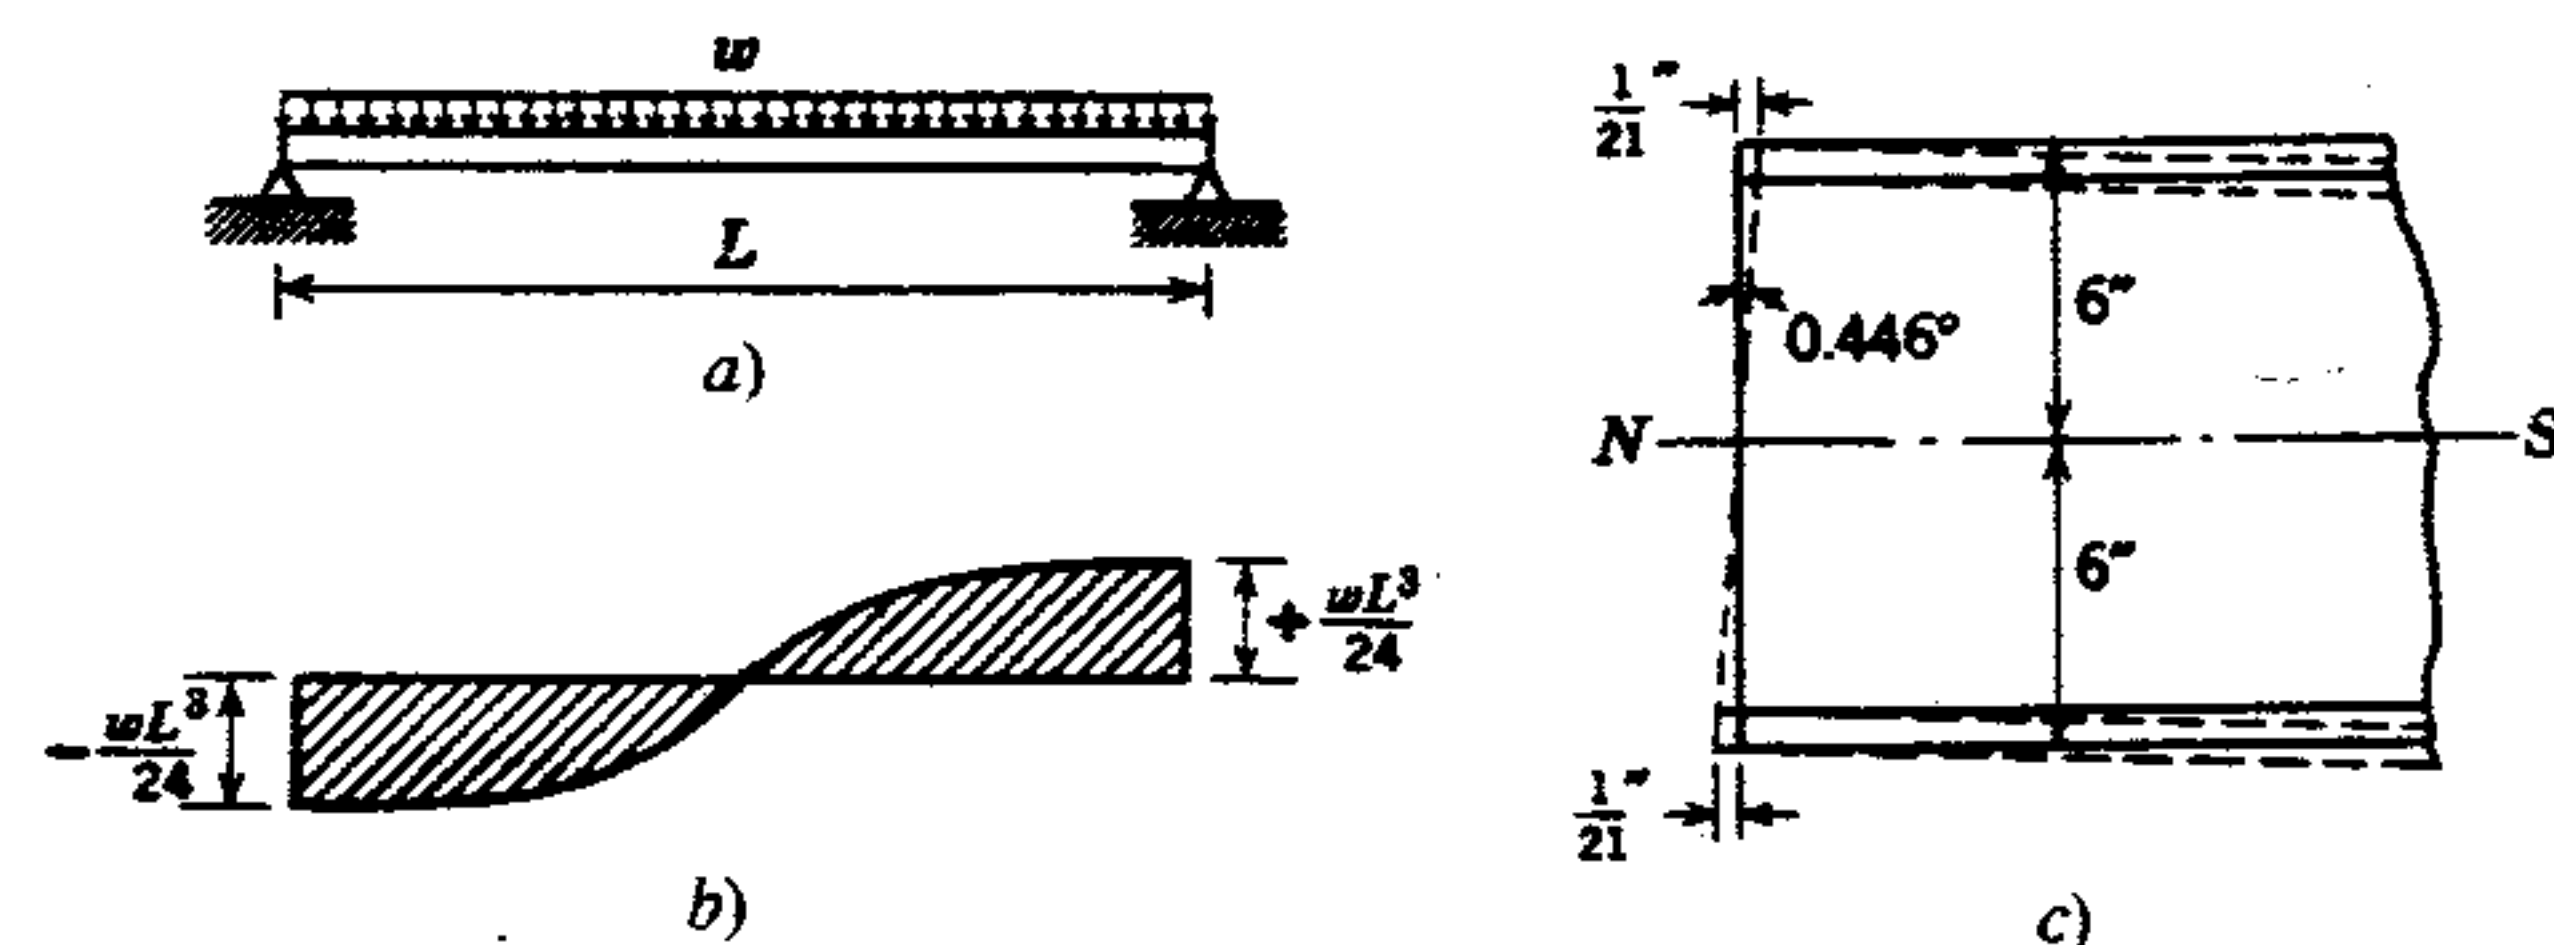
Rotación del extremo de una viga simplemente apoyada.
